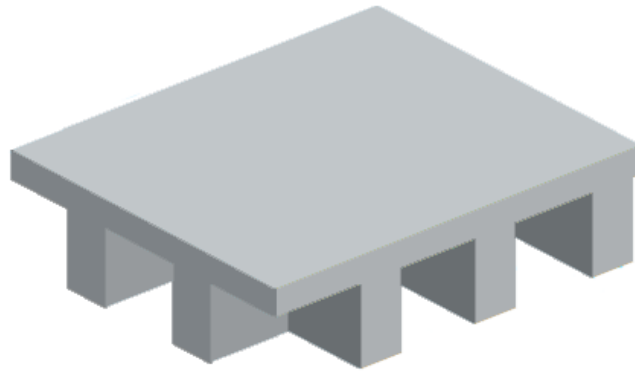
Losa casetonada tipo. Fuente: autoría propia.
